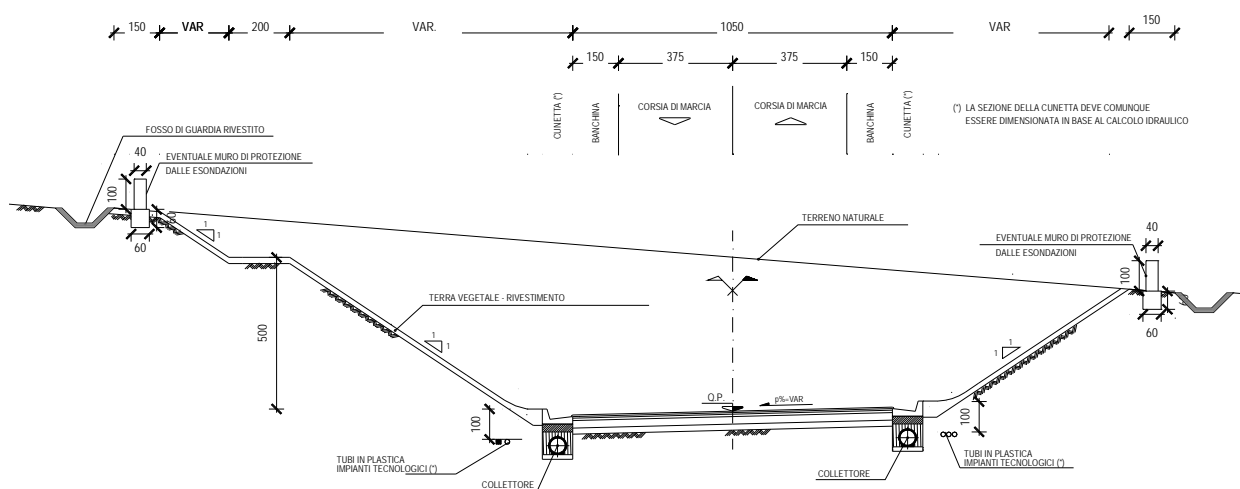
Esempio di sezione di tipo C1 in scavo.
